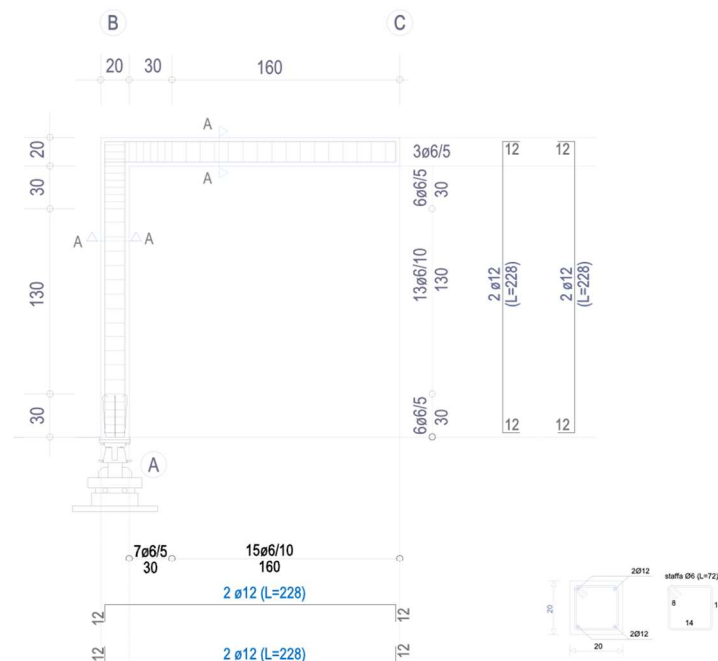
Posizionamento armatura all'interno del telaio in calcestruzzo armato
